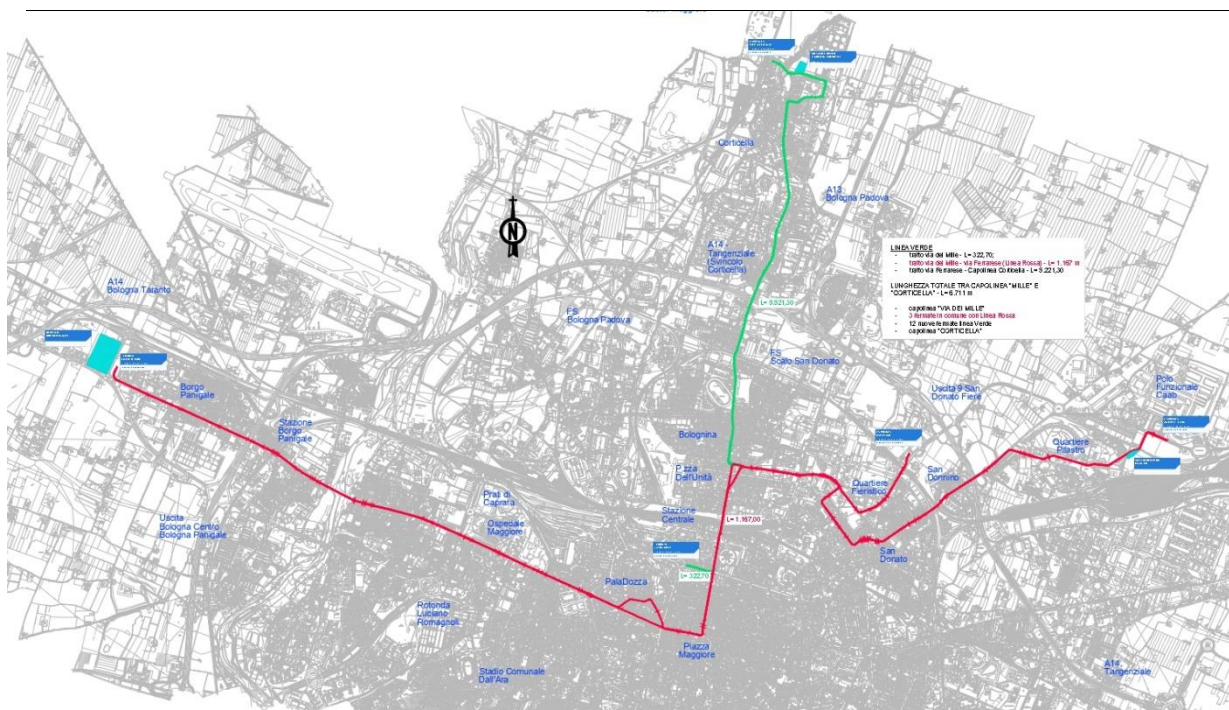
Planimetria generale Linea rossa + Tratta nord Linea Verde
